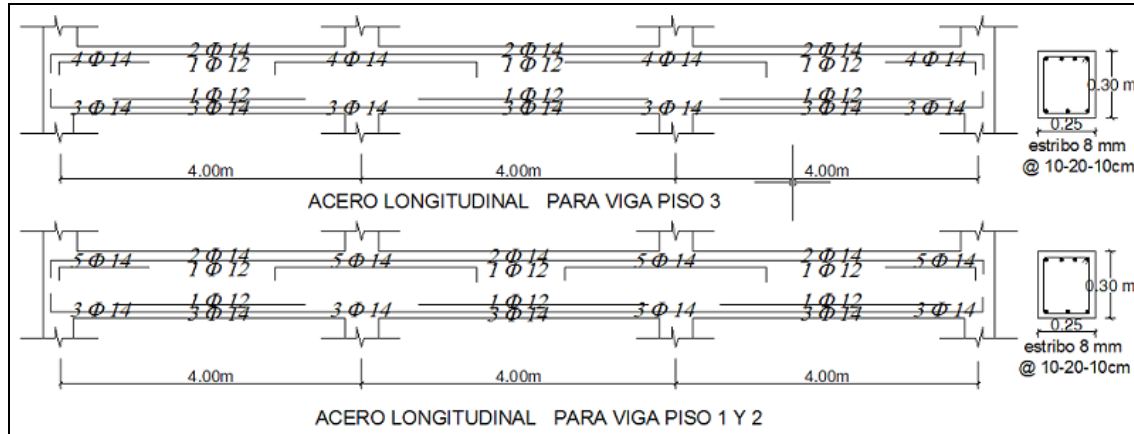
Armadura de vigas exteriores de edificio de tres pisos.
